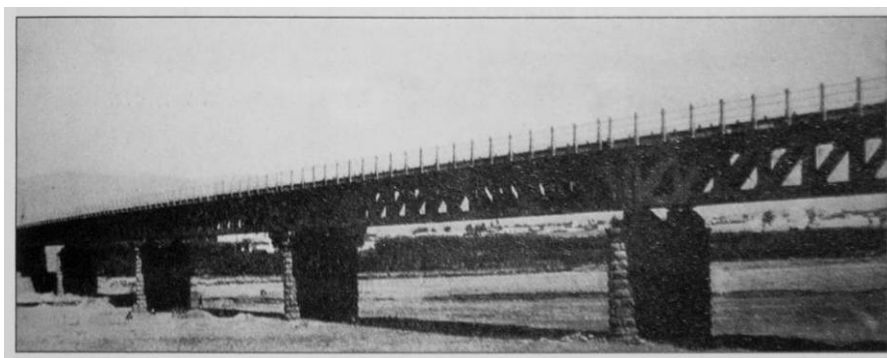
Puente sobre el río Andarax, 1927. José López Rodríguez, ingeniero de caminos.
